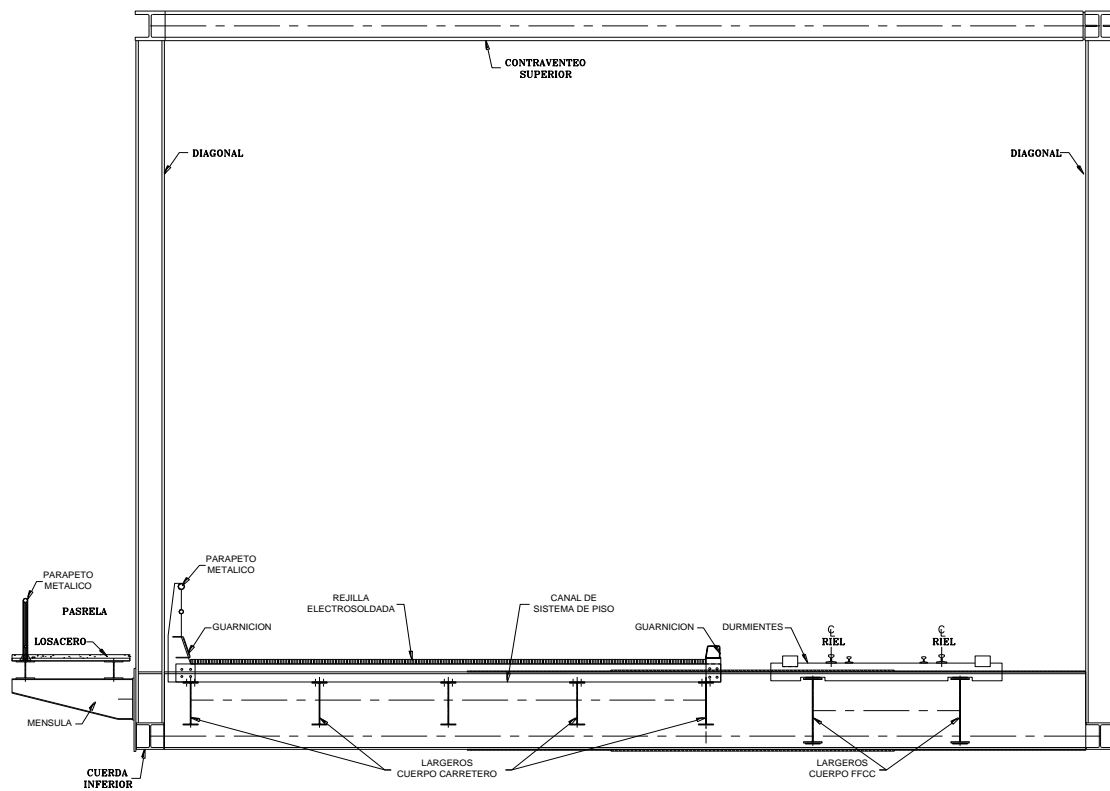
Corte transversal del tramo metálico levadizo [3.1].
